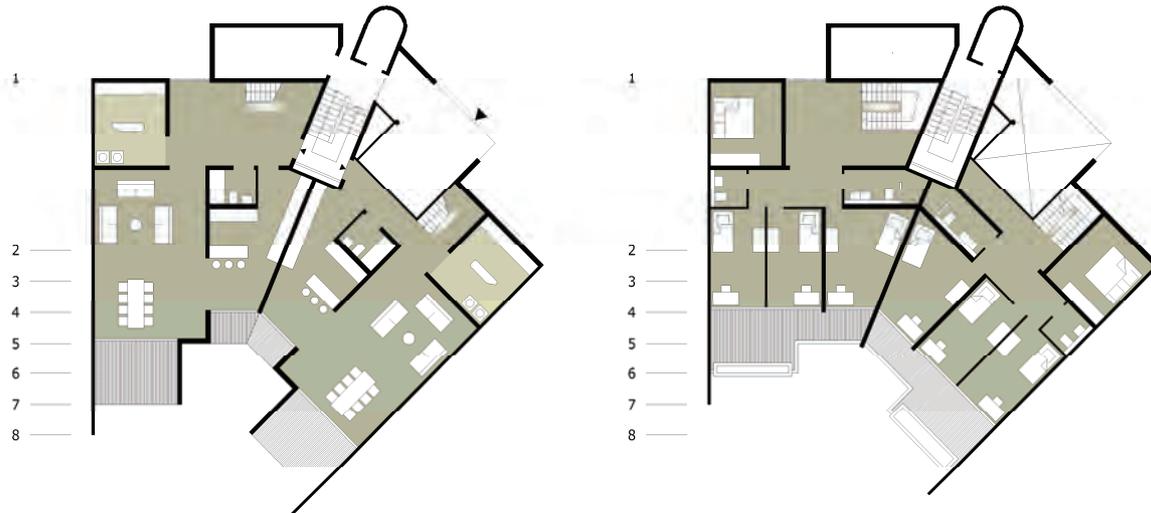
Grundrisse Entwurf Typ 14/15/16/17
